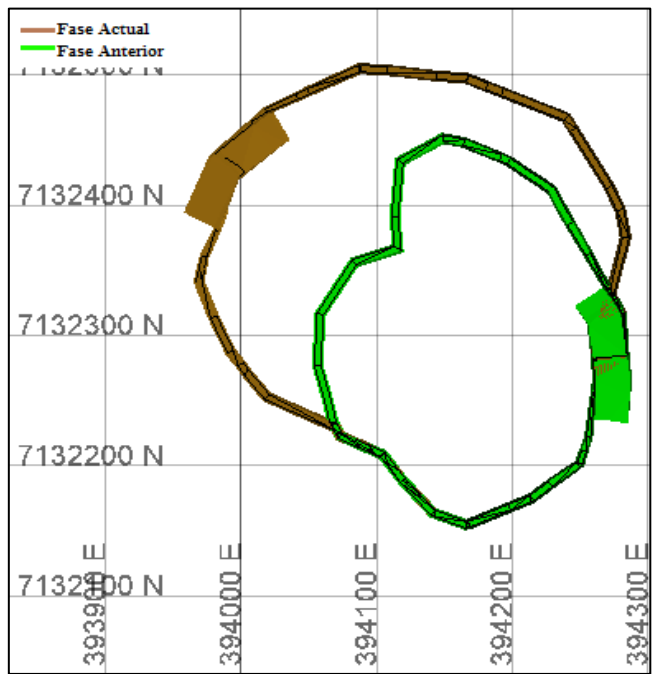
LPNB Fase 5 - Vista en sección - Planta banco 1080
